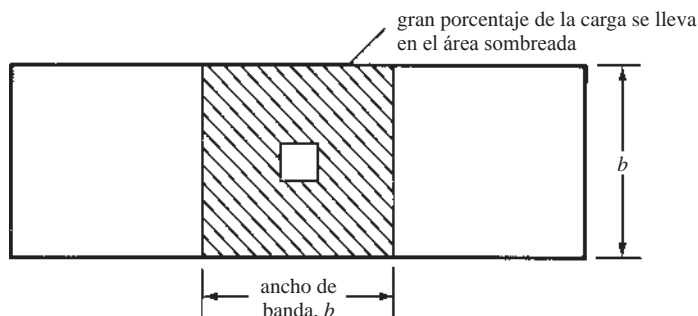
Ancho de banda para el acero en la dirección corta para zapatas rectangulares aisladas.
